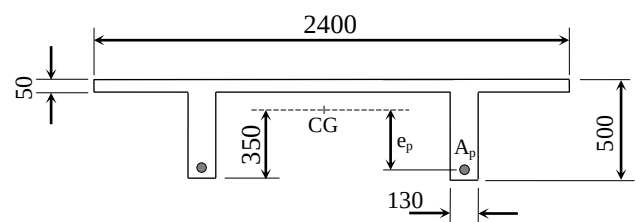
Dimensões (mm) da seção transversal da viga duplo T.
